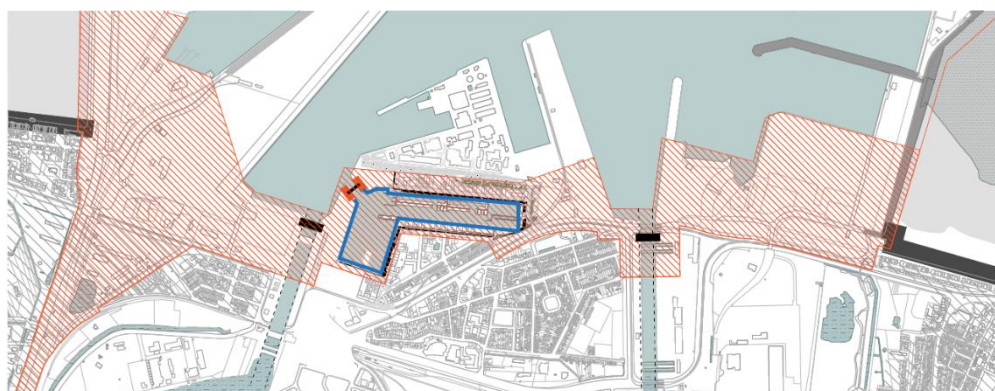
Zoom van het kustbeschermingslint ter hoogte van de Kustlaan voor het alternatief met open havenmond in de voorhaven en een stormvloedkering met sprong naar sluis in de toegang naar de jachthaven van Zeebrugge.
